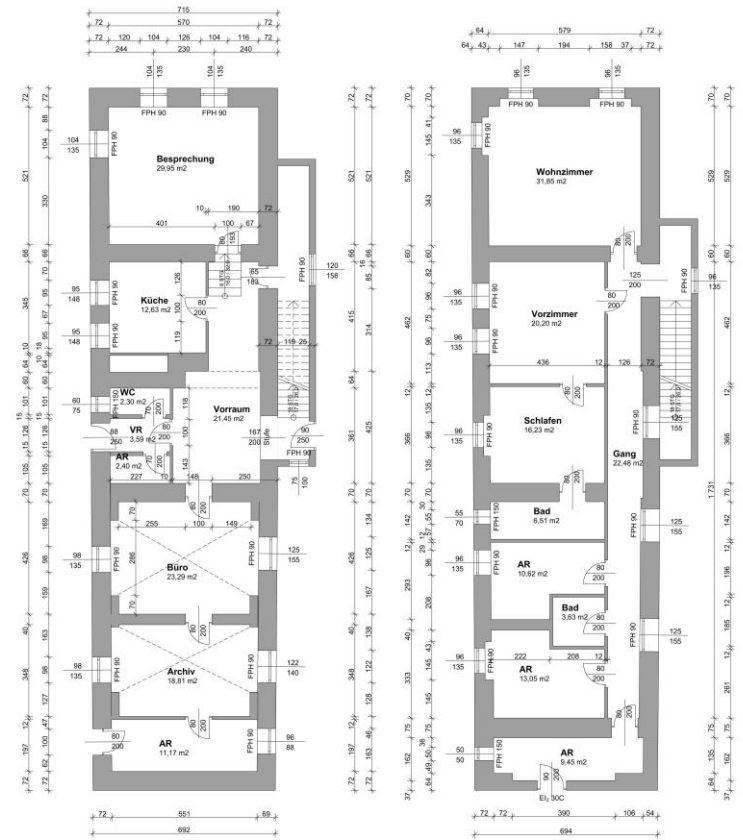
Grundrisse EG und OG, Pfarrhaus Kleinfrauenhaid.
